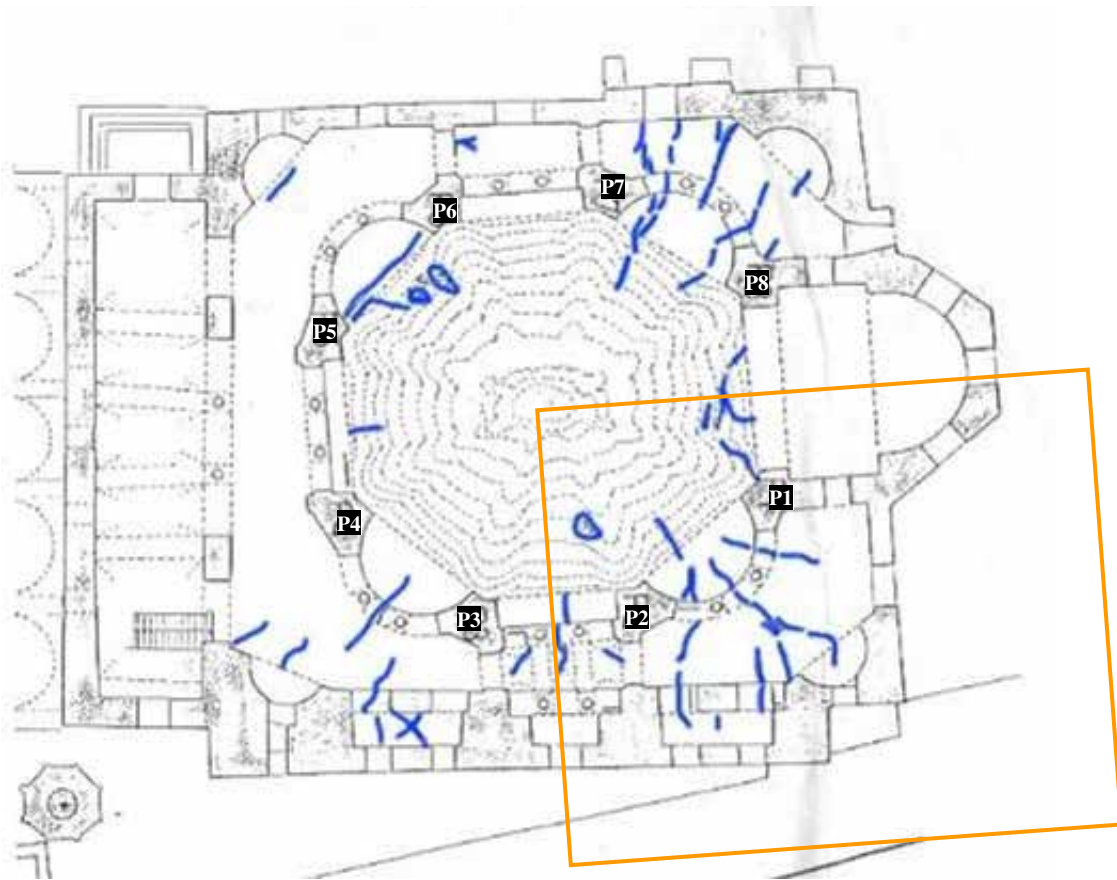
Localización en planta de grietas en el primer piso y en la cúpula de la mezquita. Se indica la  $\frac{1}{4}$  parte modelada, vid. Capítulo 6 (Arun, 2002)
